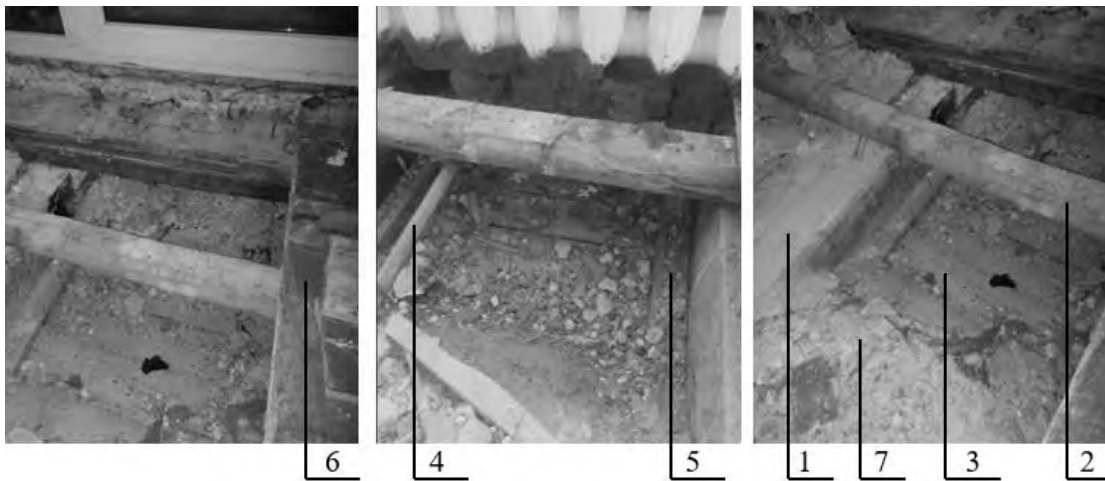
Вскрытое междуэтажное перекрытие по деревянным балкам: 1 – несущие деревянные балки; 2 – лаги; 3 – доски наката; 4 – металлический тяж, соединяющий противоположные наружные стены; 5 – черепные бруски; 6 – доски пола; 7 – засыпной шлак
